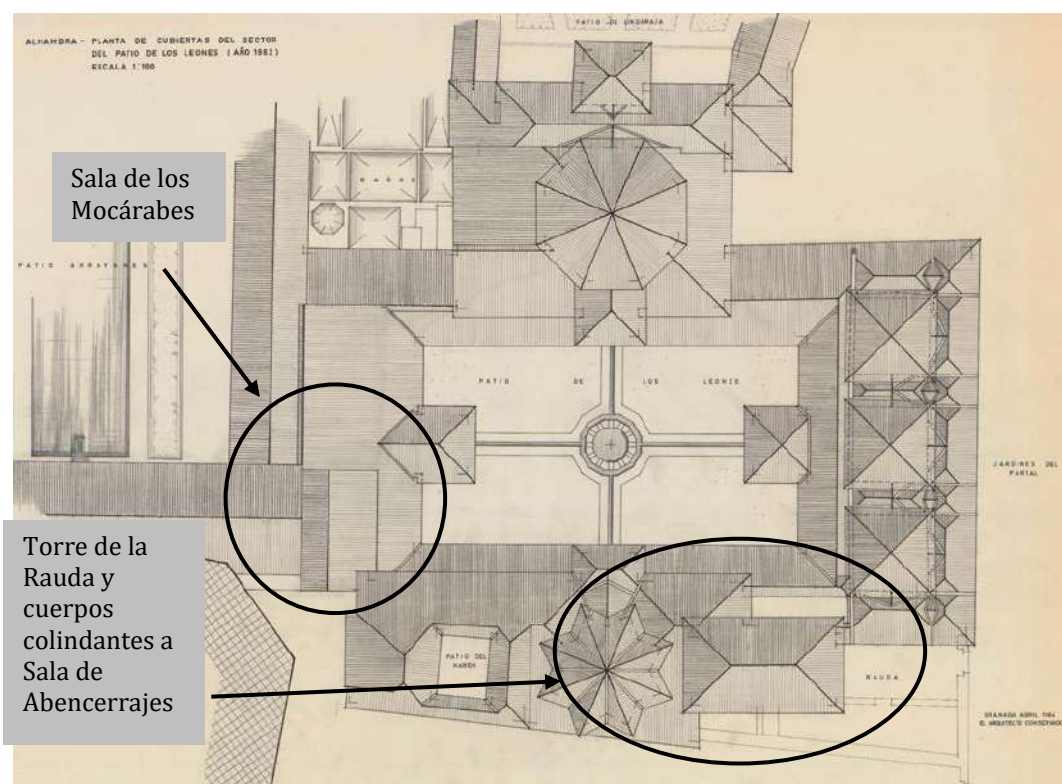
Planta de cubiertas. Estado actual. En la planimetría hemos señalado las cubiertas que este arquitecto transforma. Manuel López Reche (delineante), Prieto Moreno, 1962. (APAG/Colección de Planos/002409).
